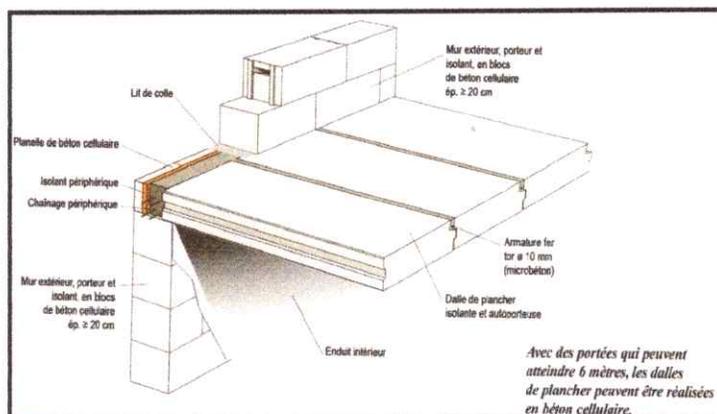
schéma de coupe planché ou mur en béton cellulaire
